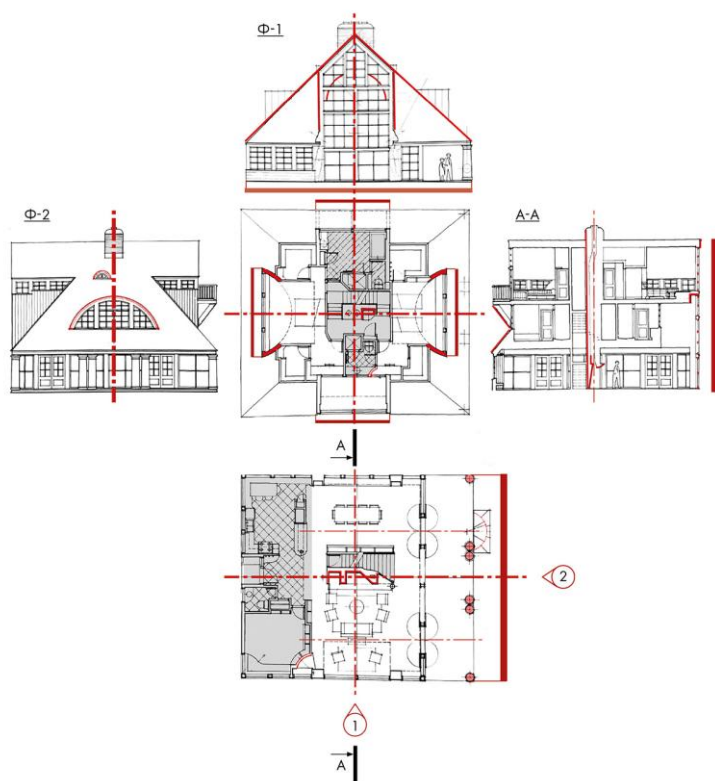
Дом на Лонг-Айленде I, арх. Роберт Вентури. Чертежи плана, фасадов и разрезов
